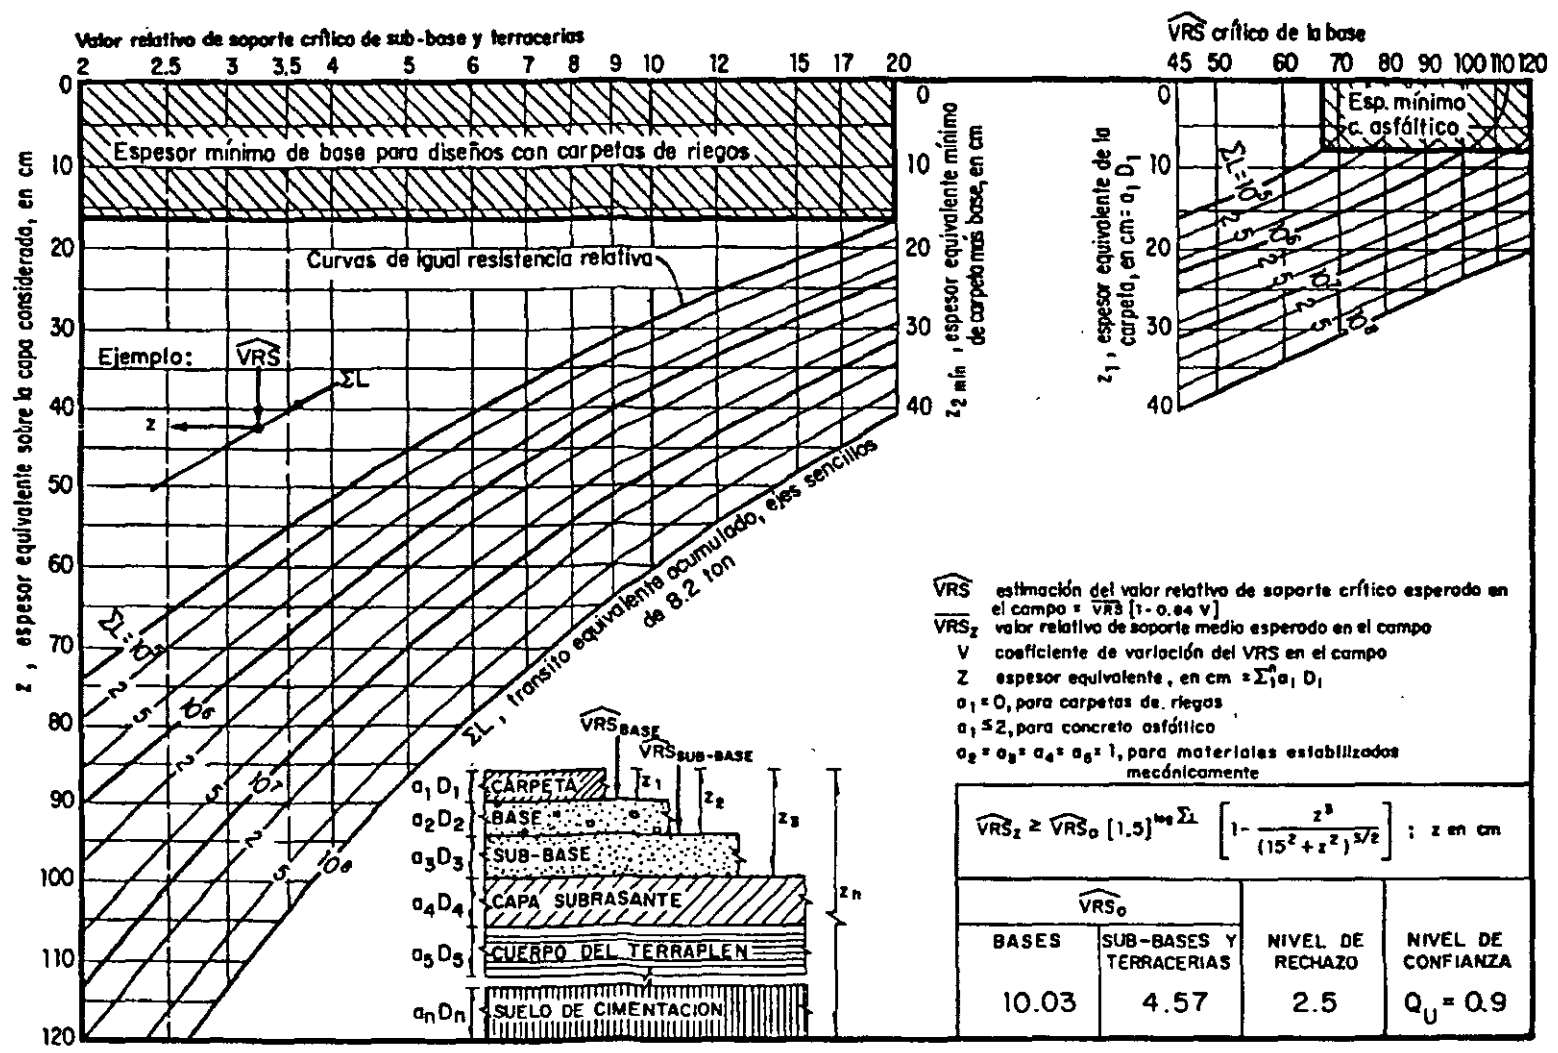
GRÁFICA PARA DISEÑO ESTRUCTURAL DE CARRETERAS CON PAVIMENTO FLEXIBLE.
